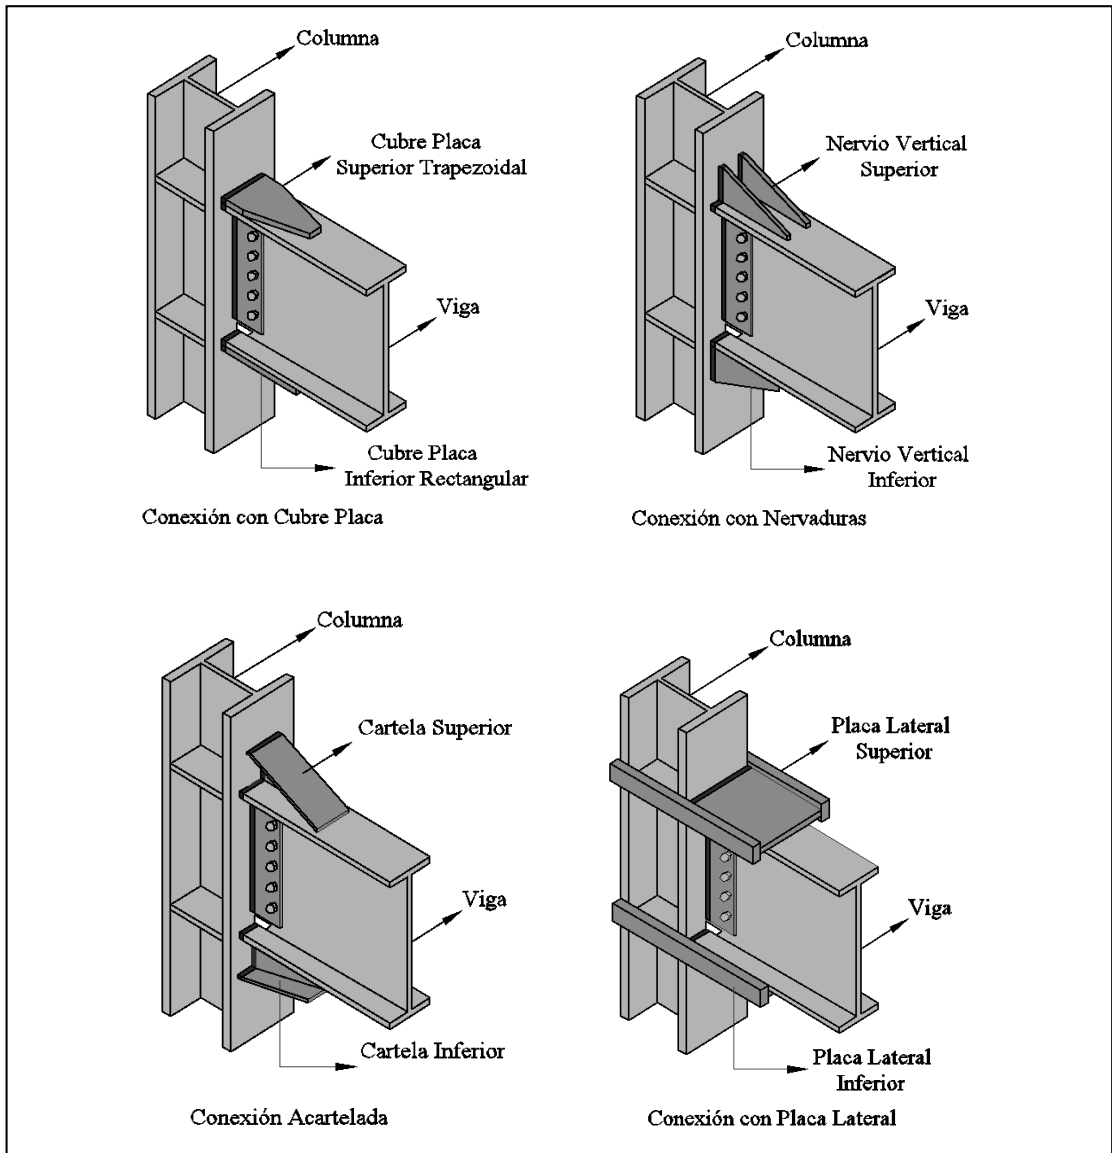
Propuestas Iniciales de Reforzamiento de Conexión Viga-Columna
